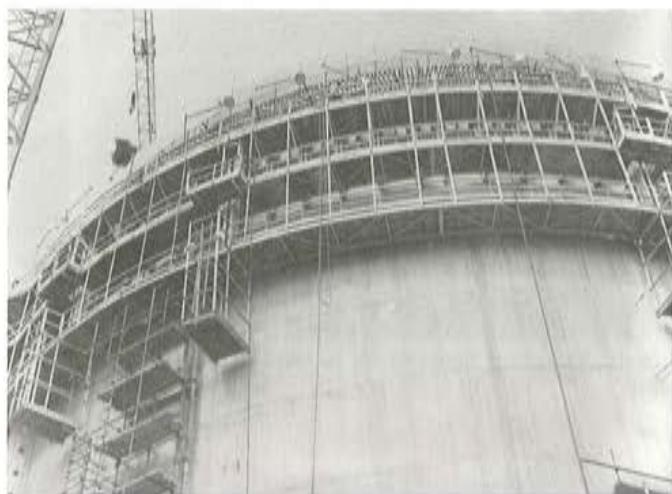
Fase de construcción Edificios Principales Grupo II.
